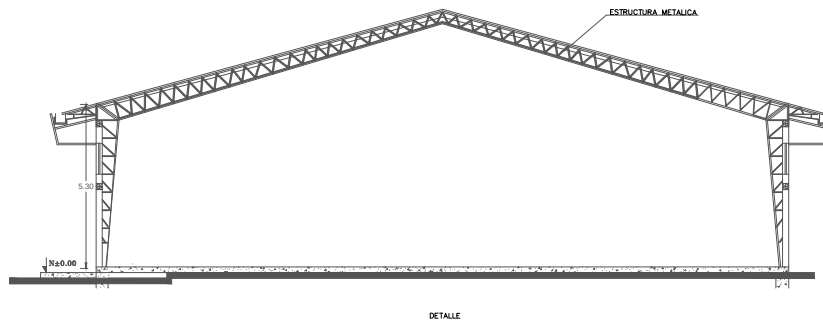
Sección de la plaza “Mercado de los Plátanos”
